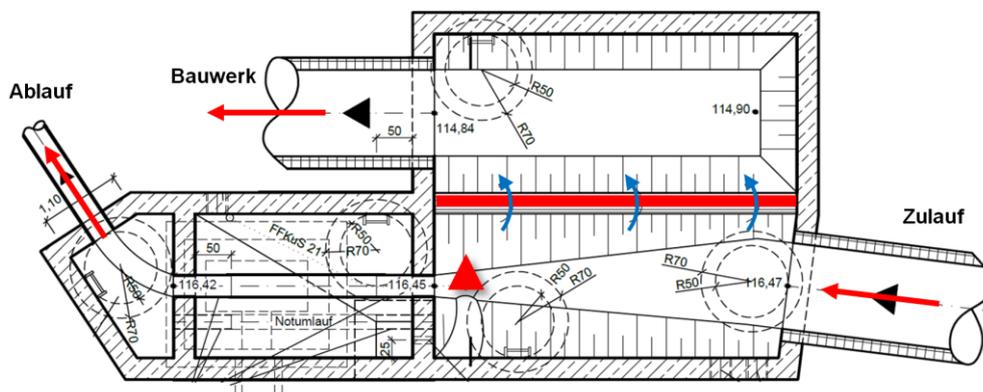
Grundriss des RÜB „Nebenschluss“ aus Planunterlagen
